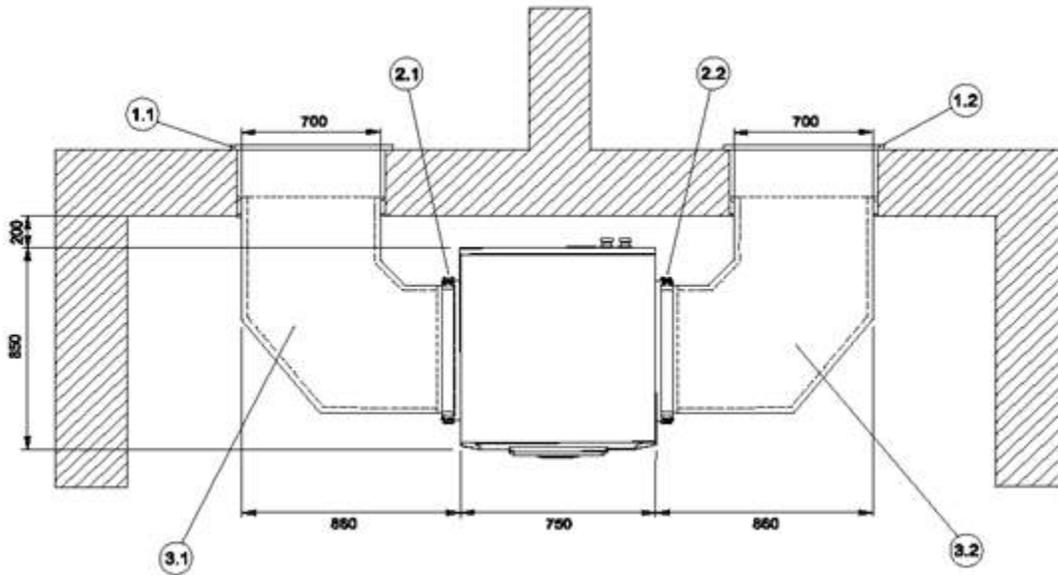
Vista dall'alto - LI 16TES, LI 20TES (installazione a parete con canale aria lato aspirazione e lato scarico)
